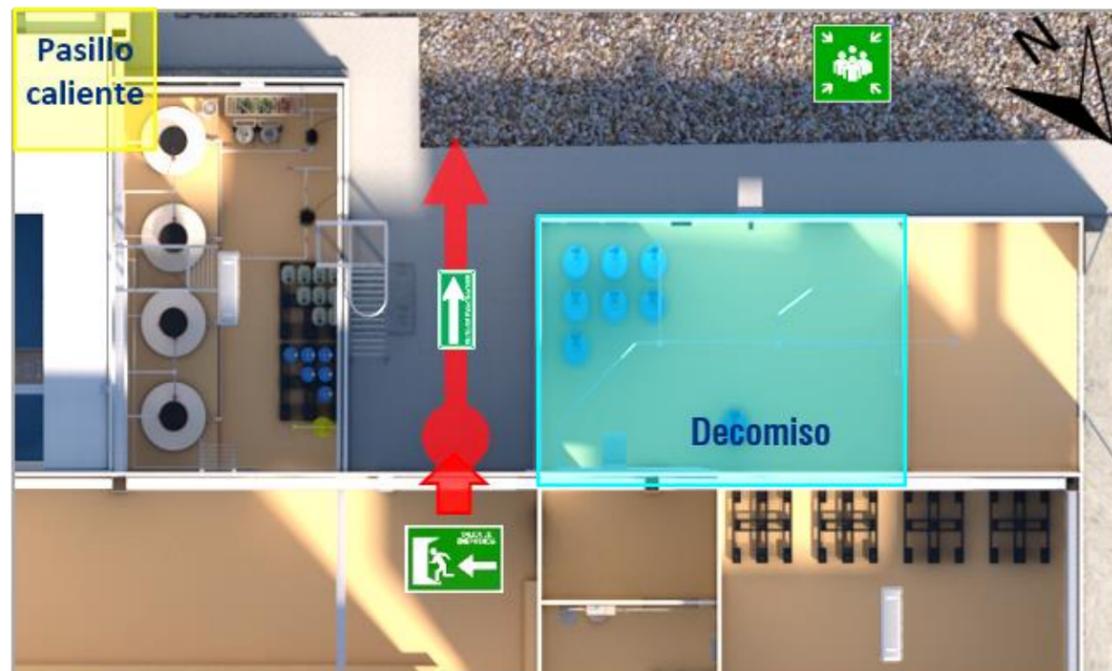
Planta existente y propuesta de decomiso de cabeza. Fuente: Carpeta de proyecto.
